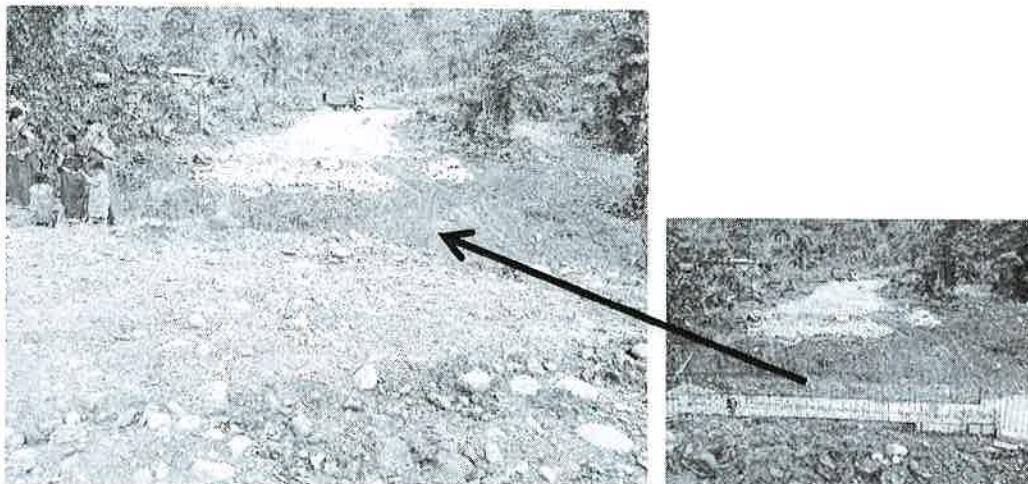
Se observa mujeres y niños en el área de construcción del puente sobre el Rio Guariviara.
